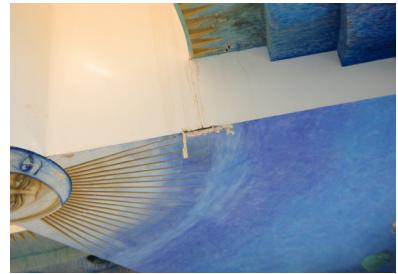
Fotografías generales tomadas a la obra en su conjunto.
